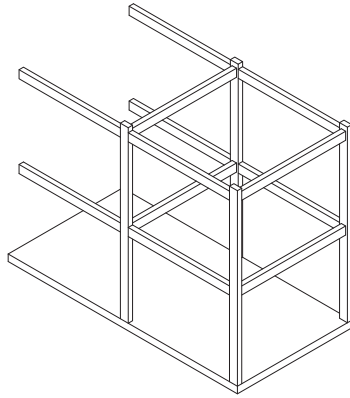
Axonometría constructiva sistema viga-pilar de madera.
